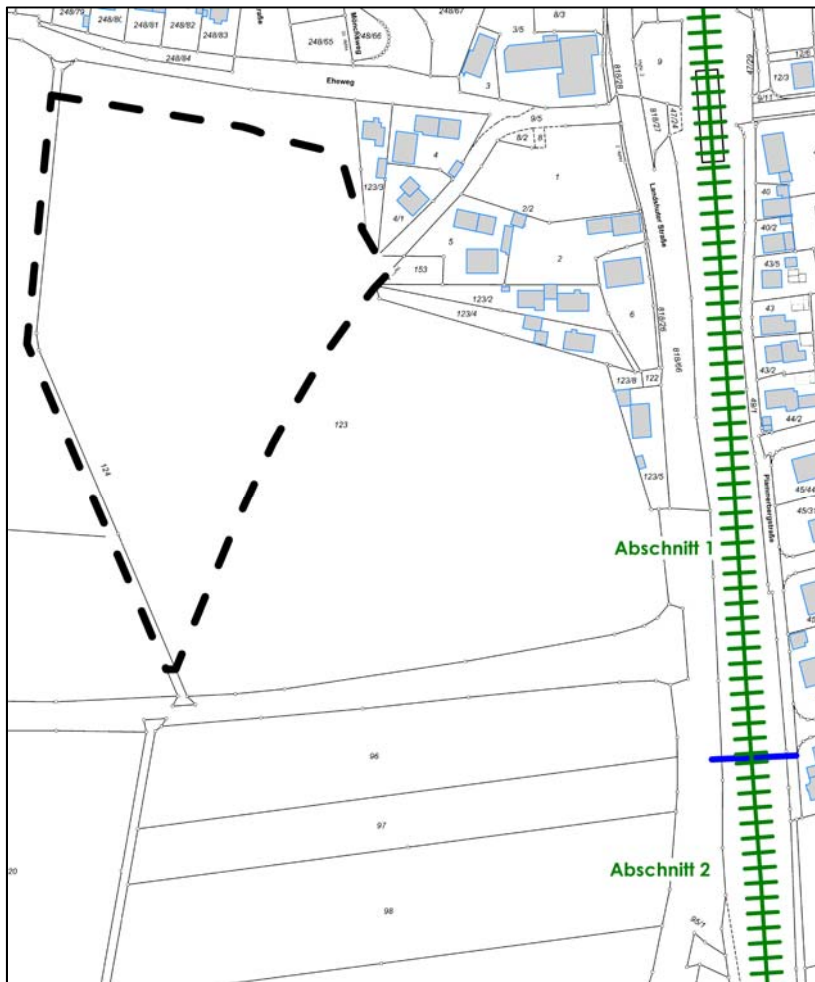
Lageplan mit Eintragung der beiden Streckenabschnitte
